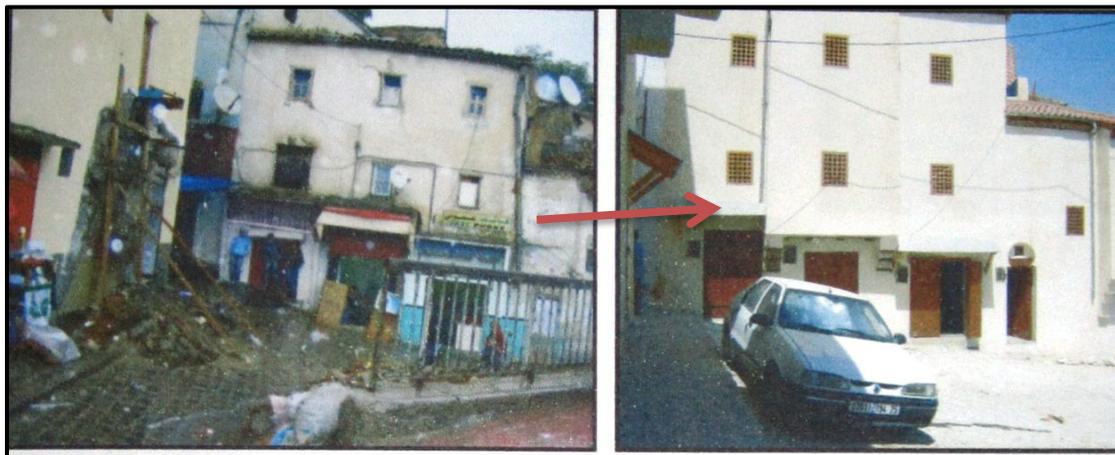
restitution du style architectural traditionnel d'une maison sur la rue mellah S
